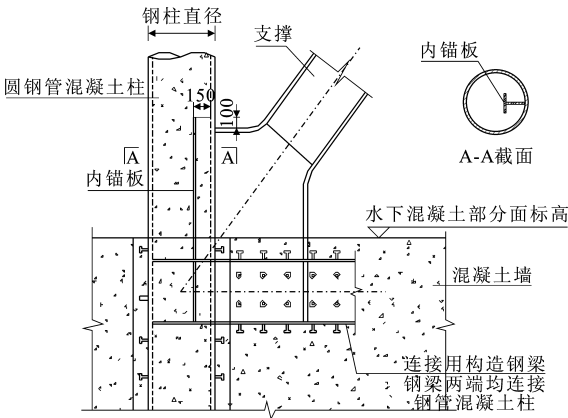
钢支撑与地下剪力墙连接节点(单位:mm)
